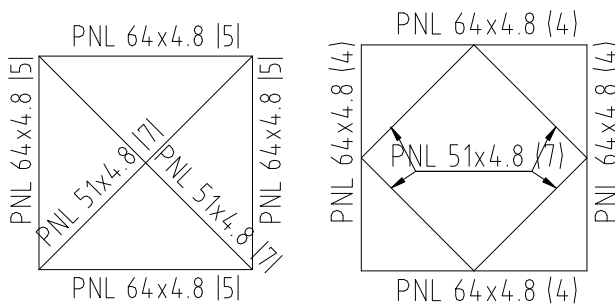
Antes y después de las diagonales interiores de las columnas en planta.
